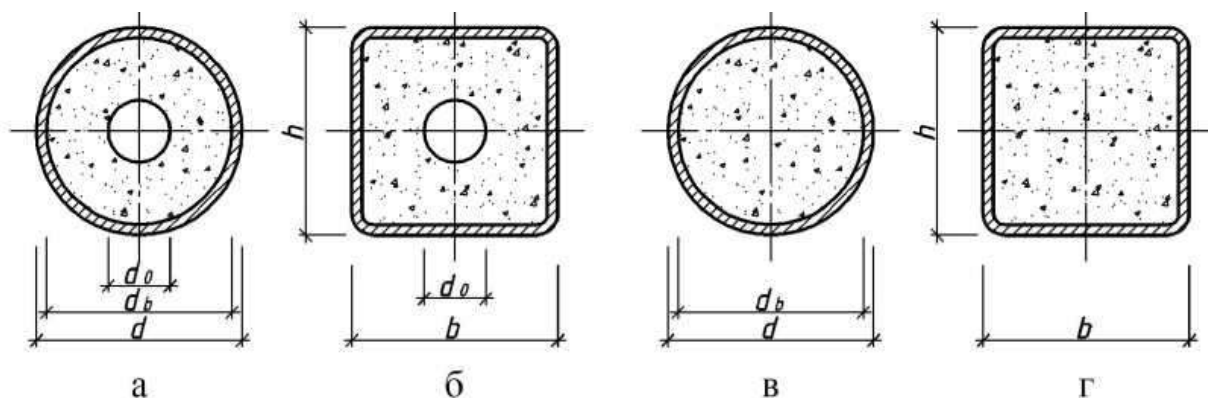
Форми поперечних перерізів і варіанти армування бетонного ядра трубобетонних колон
